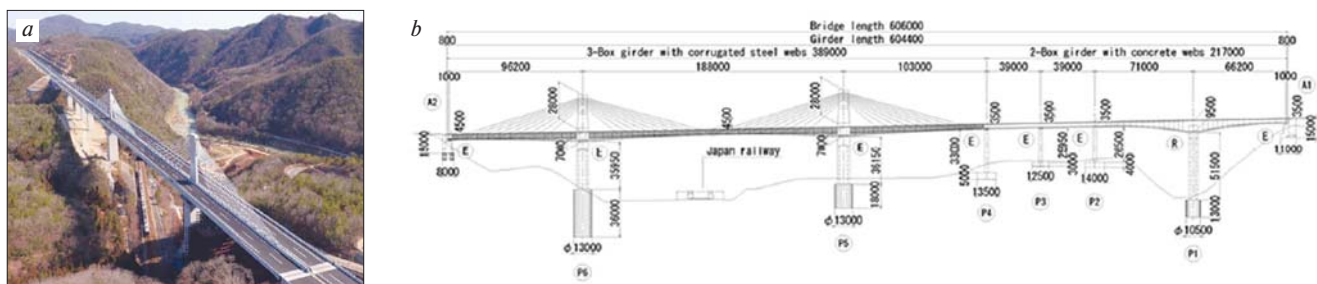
Мост Ikuno Bridge (Япония) вантовой конструкции через глубокое ущелье (а) и расчетная схема моста (b)
